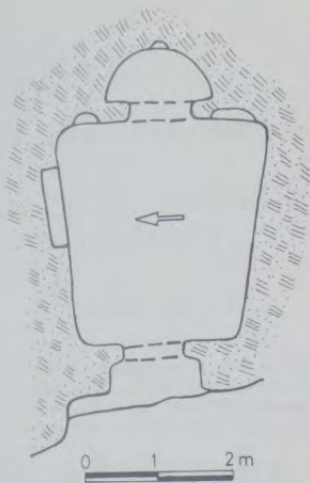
Ihlara, Grundrisskizze der Kordele Kilise
